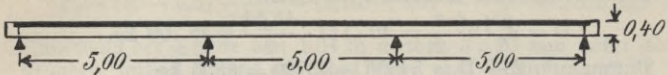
Kontinuierlicher Plattenbalken mit drei Öffnungen.
